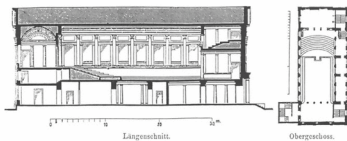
Längsschnitt und Grundriß der Singakademie nach dem Umbau 1865 (Architekten-Verein zu Berlin 1877a, 340-341)
